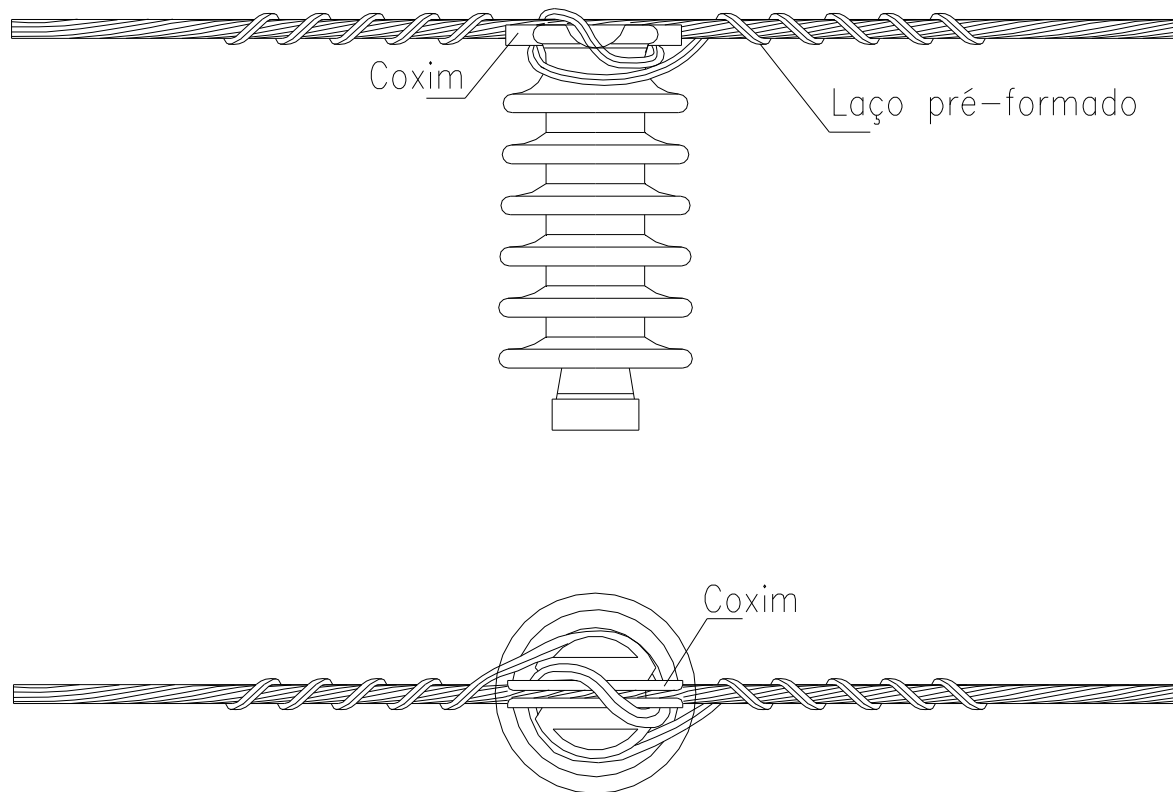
Amarrações e ligações – Primário – Amarração simples de topo
